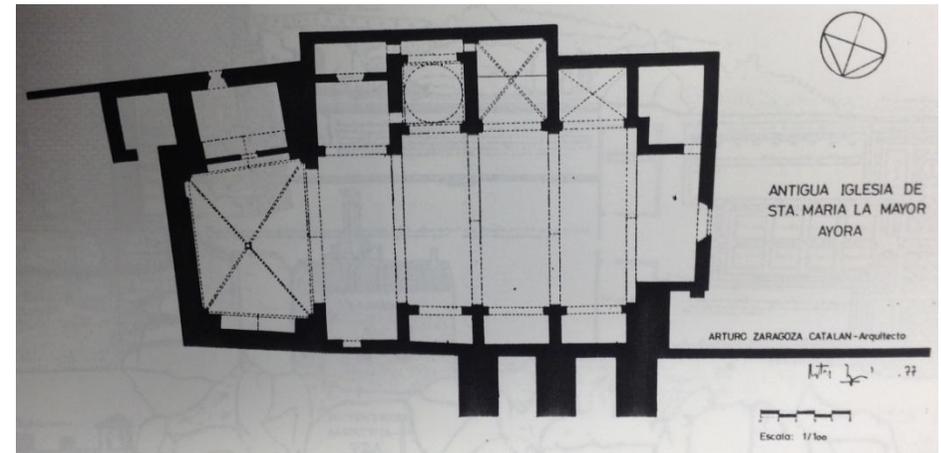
Planta del edificio en 1978. (Zaragoza, 1980: 5)
